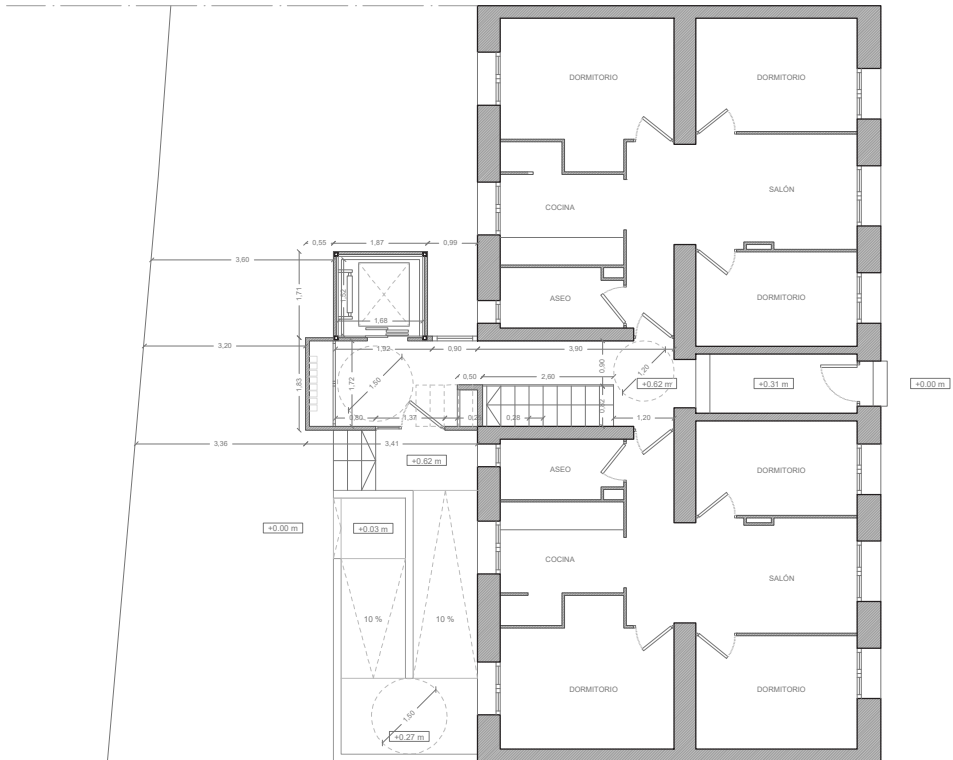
Zoom núcleo planta baja (e: 1/150).
